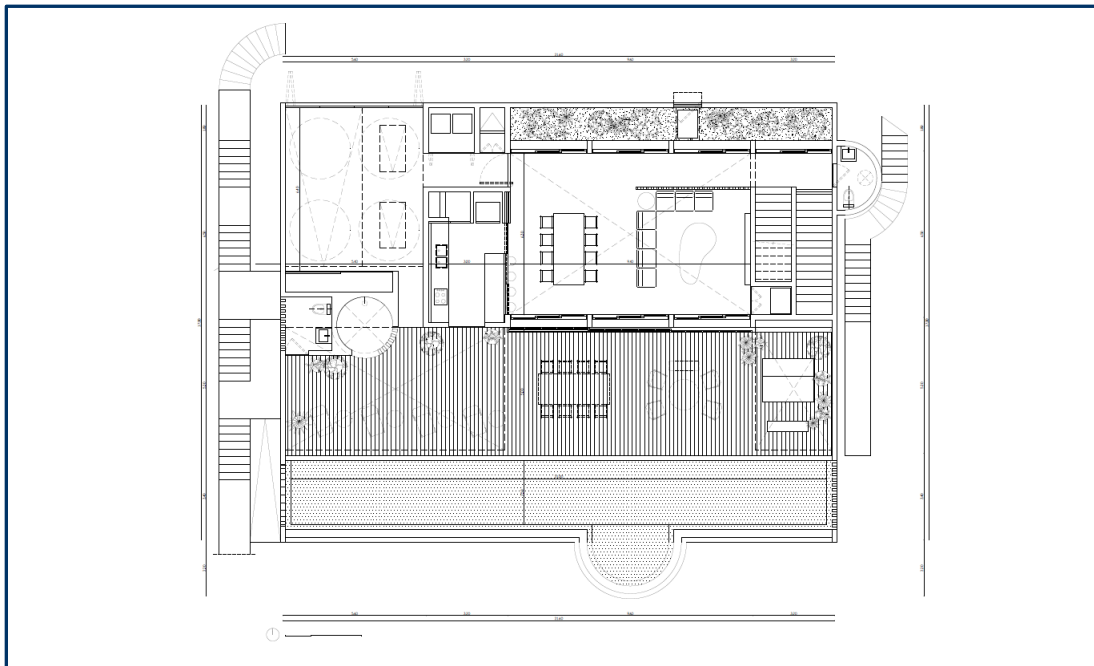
Casa Etziakame Nivel 0 (Planta baja).
